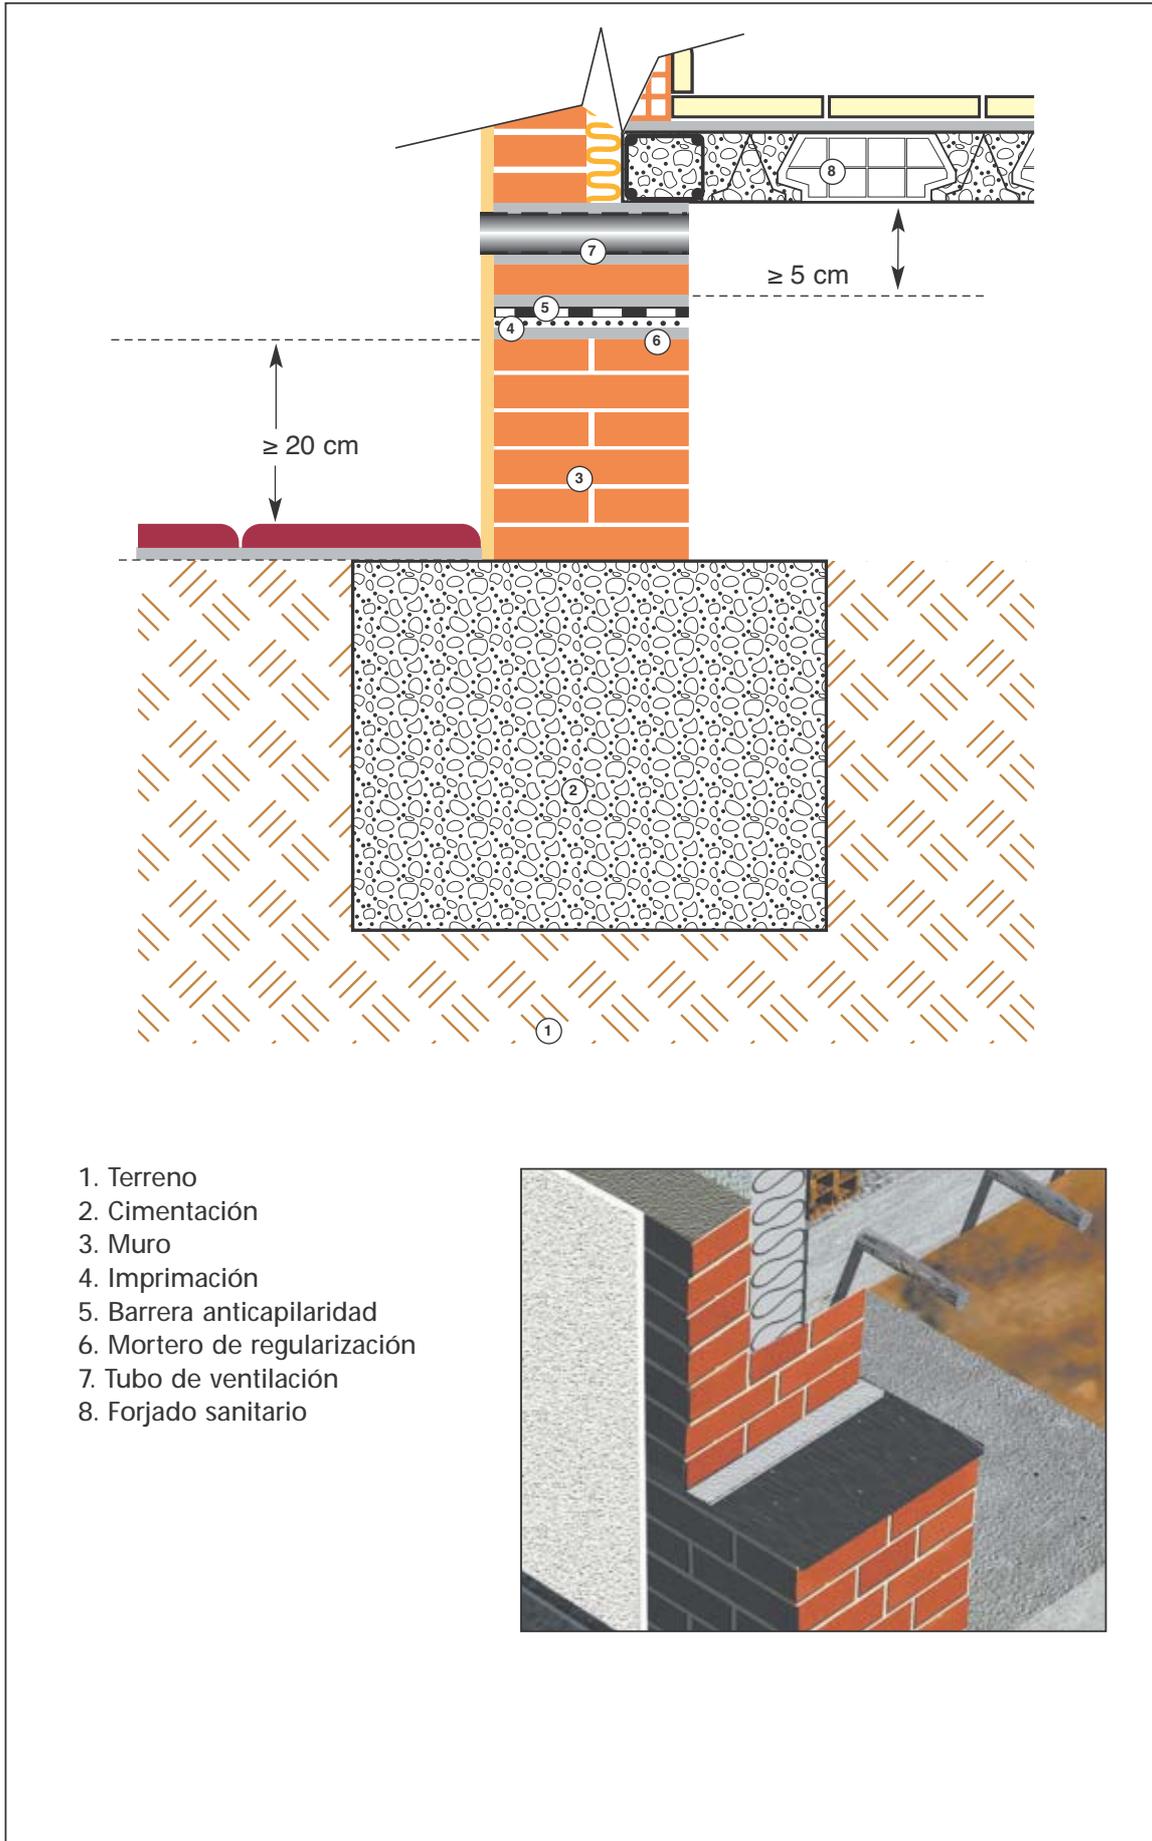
Barrera anticapilaridad en una cimentación corrida con forjado sanitario
